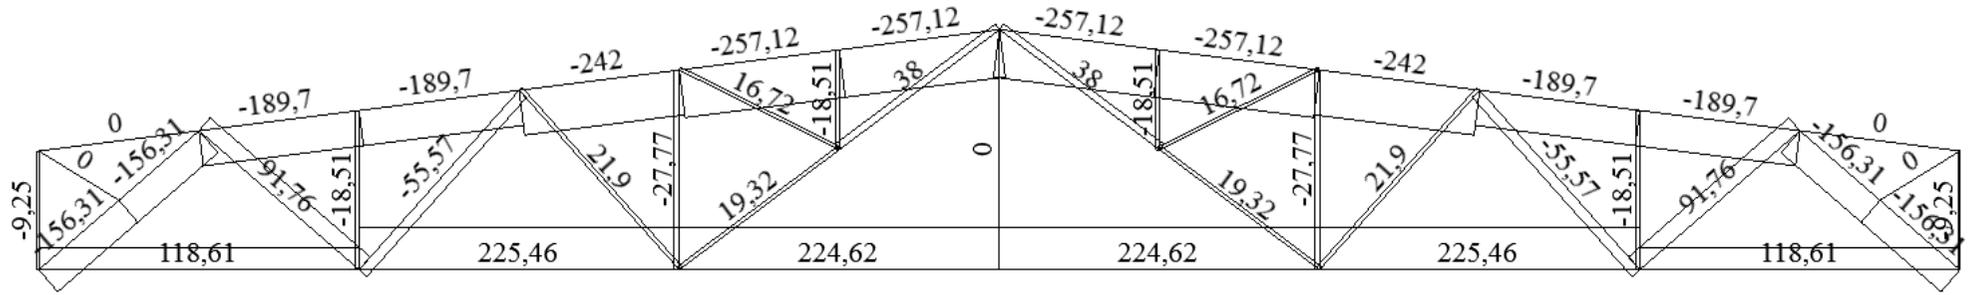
Эпюра внутренних усилий от постоянной нагрузки
